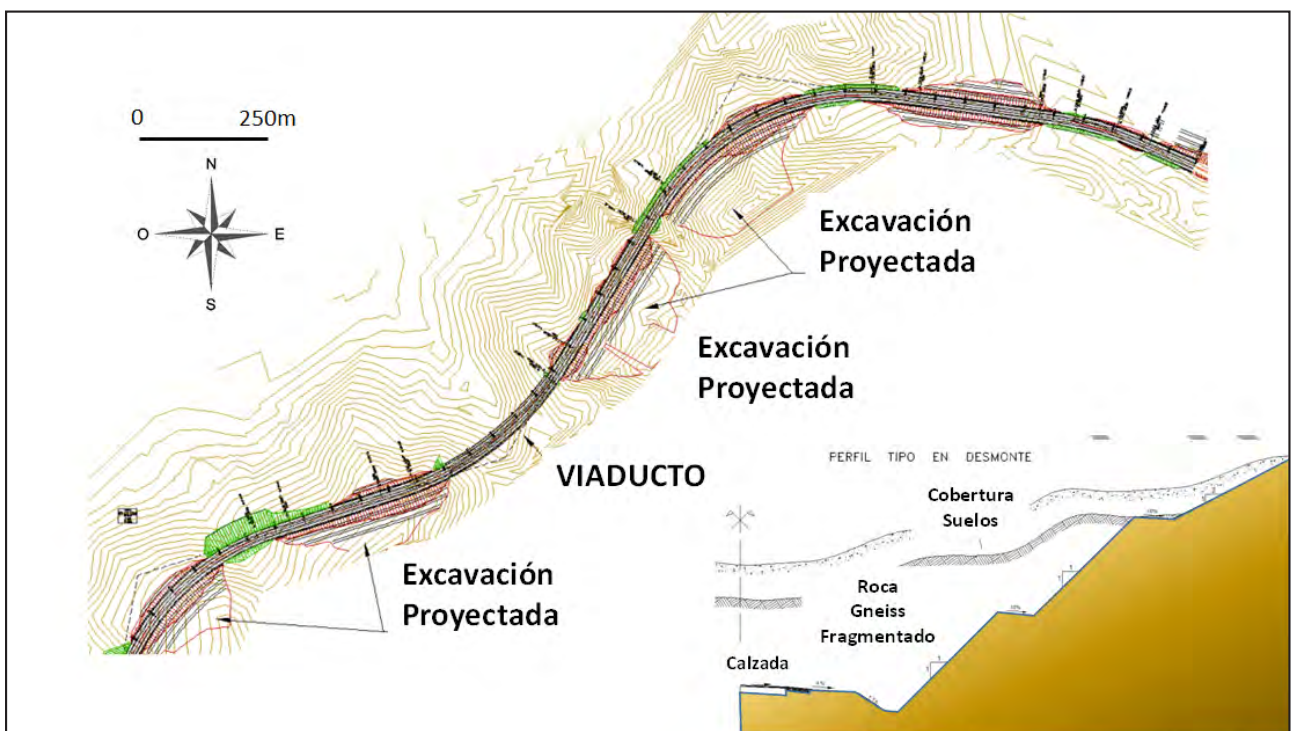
Propuesta inicial de tratamiento del sector a través de excavación y terraplenado.
